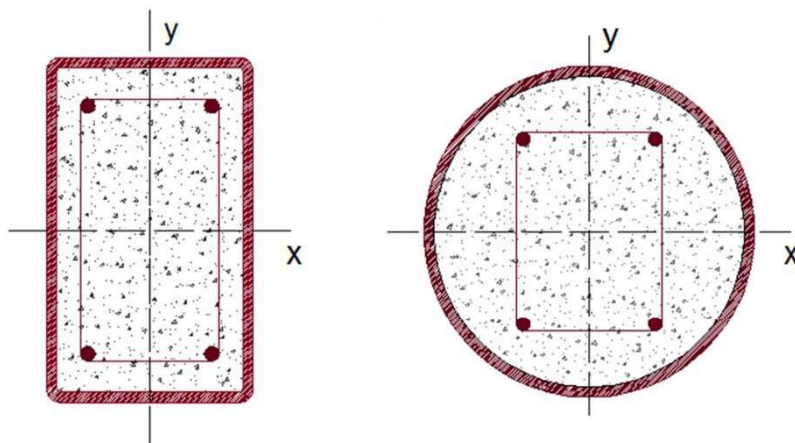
Algumas configurações de pilares preenchidos com armadura adicional.
